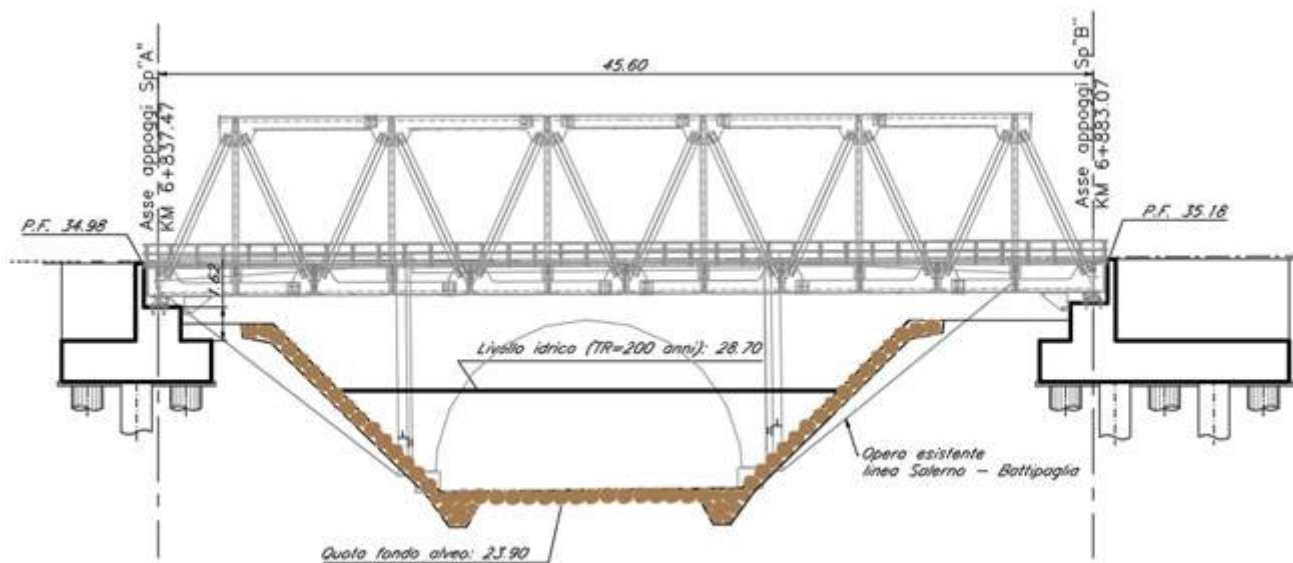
Profilo longitudinale VI-03 Ponte Asa
